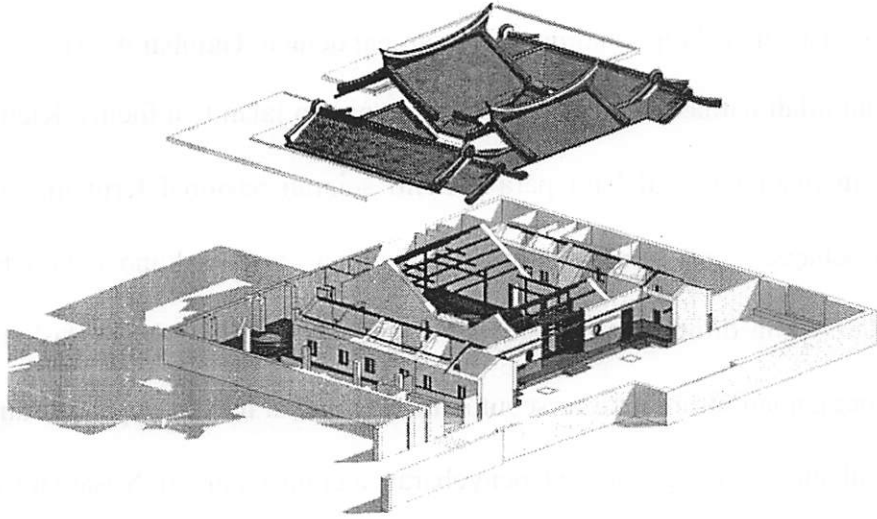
3D denah klenteng Hok Tek Bio.
